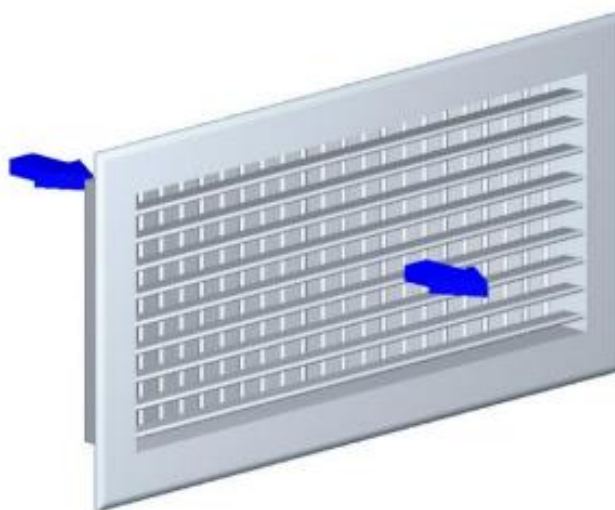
Rejilla de impulsión. Fuente: kventil.com
